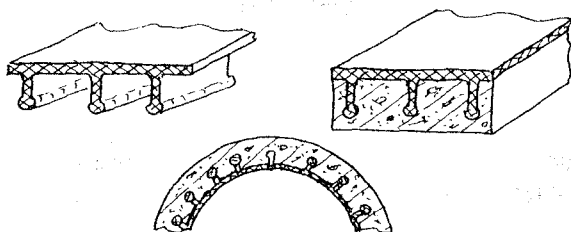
Использование полиэтиленового листа с армированными ребрами в различных конструкциях
